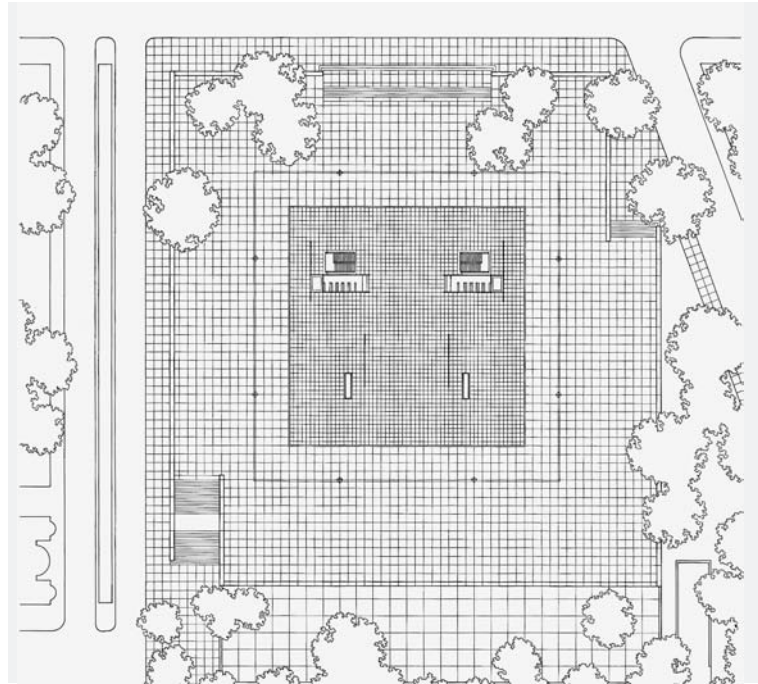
Ludwig Mies van der Rohe, Galerie des 20. Jahrhunderts, Berlin, 1926–28. Lageplan mit Grundriss der Ausstellungshalle.
